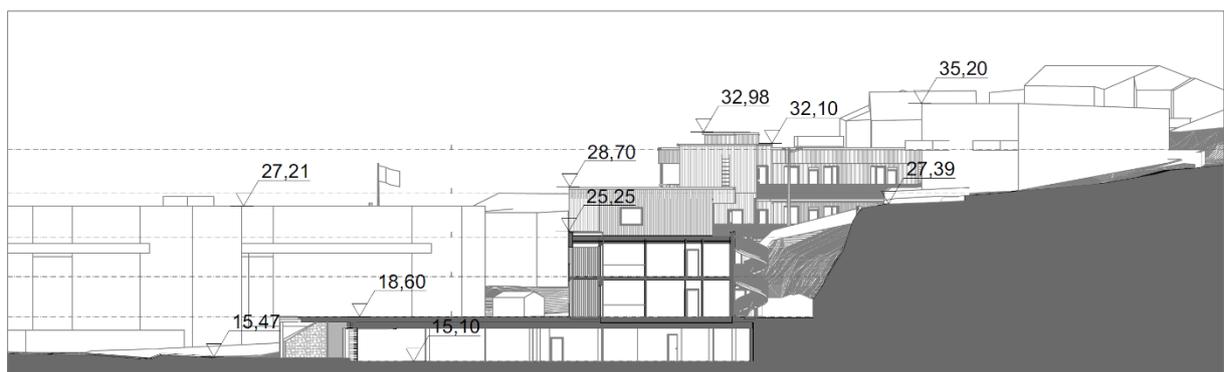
Byggehøgden er tilpassa bygget ovanfor i terrenget. Naboane vil framleis ha sikt mot sundet.
